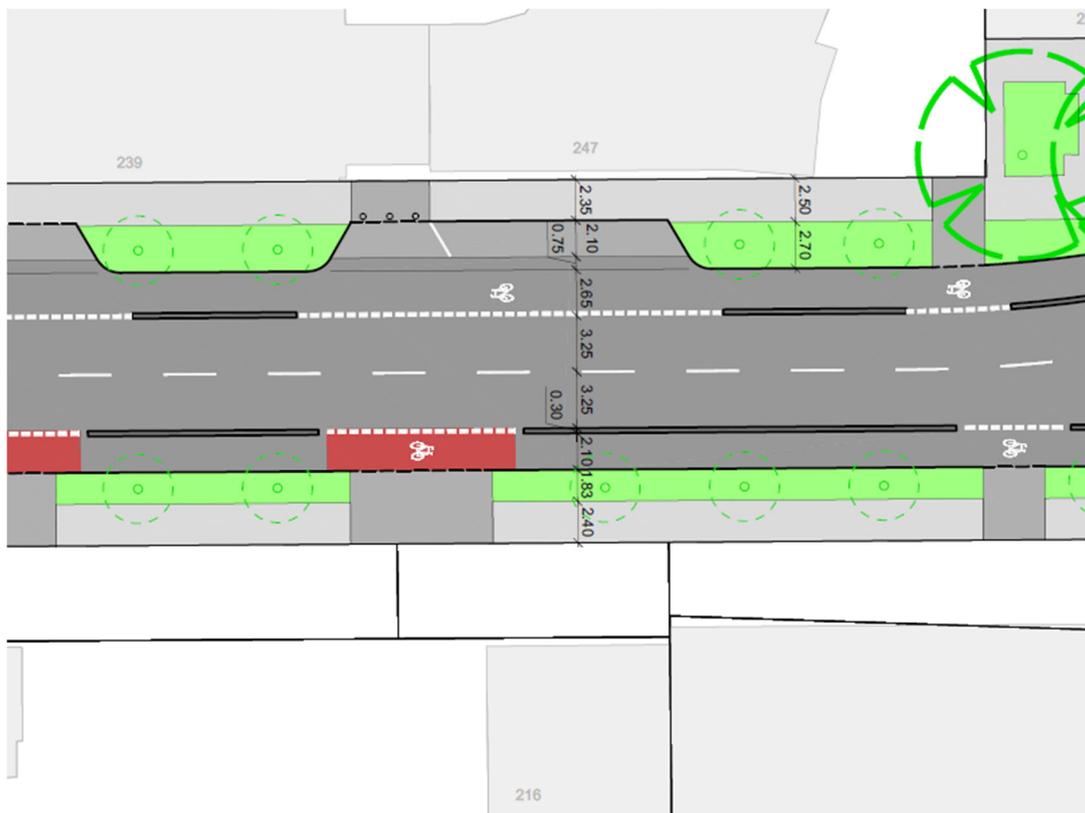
vereinfachter Lageplan Variante LSA-Knotenpunkt - Abschnitt Strecke, LSBG
